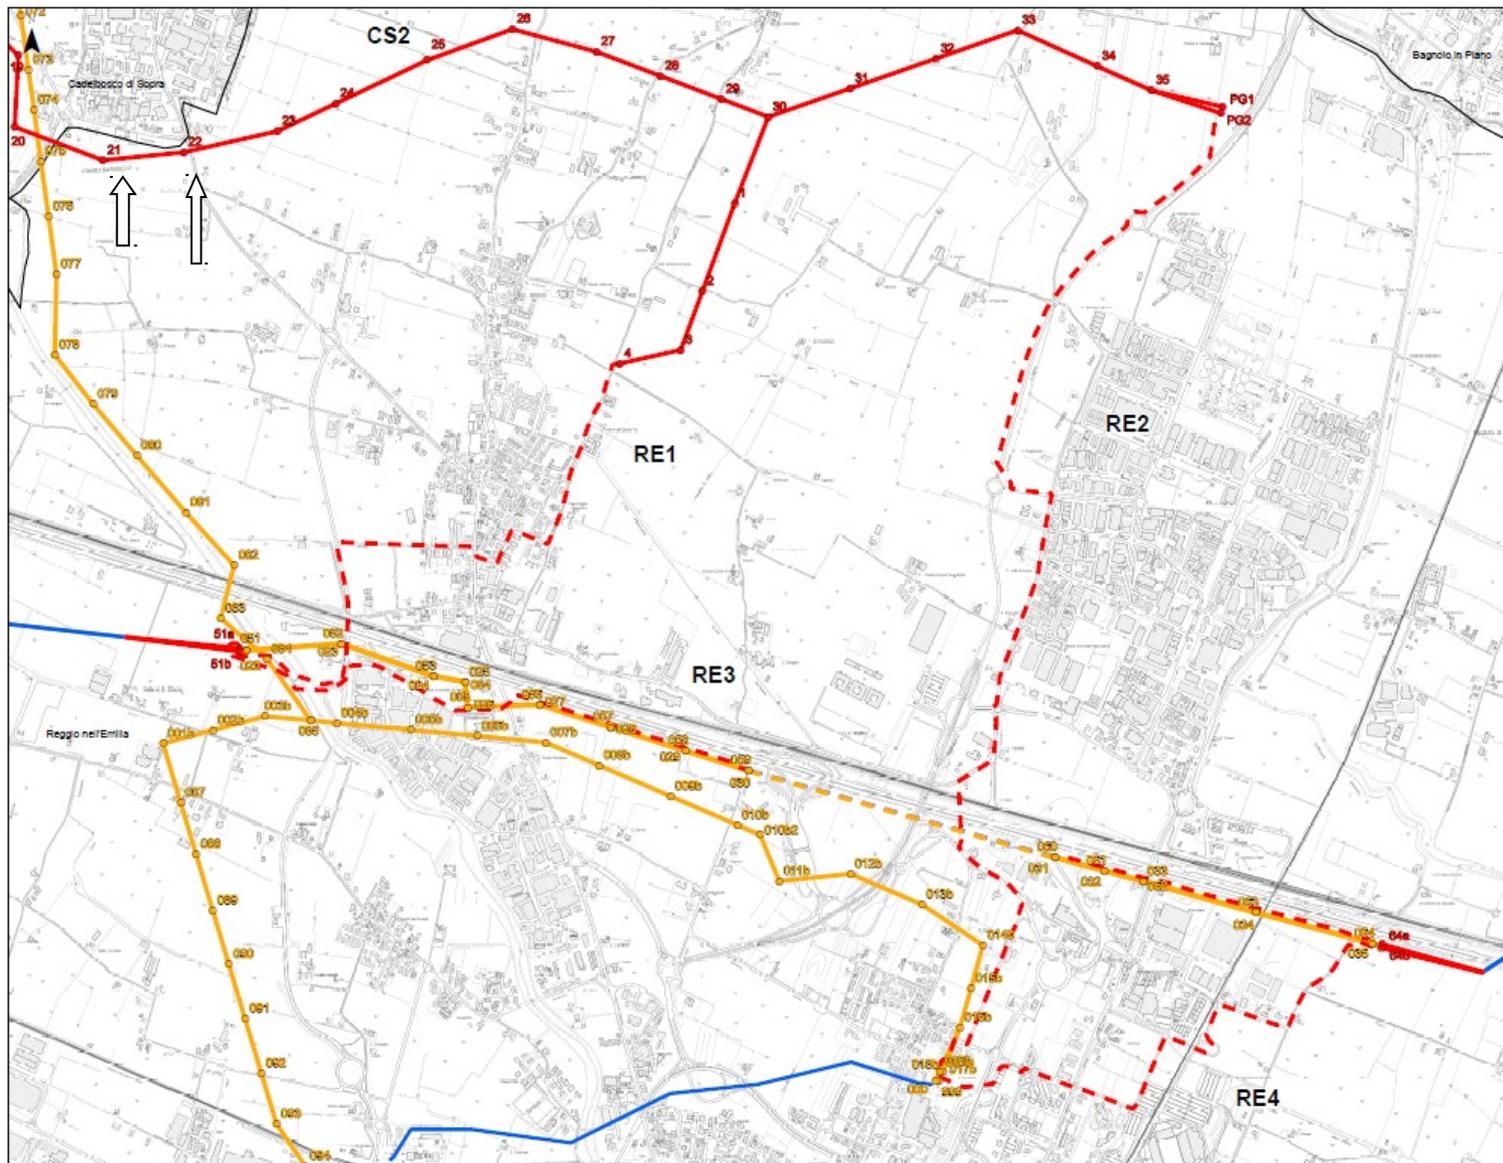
Planimetria progetto 31/01/2021 (tratta da elaborato Terna DU0000006B1937737)
